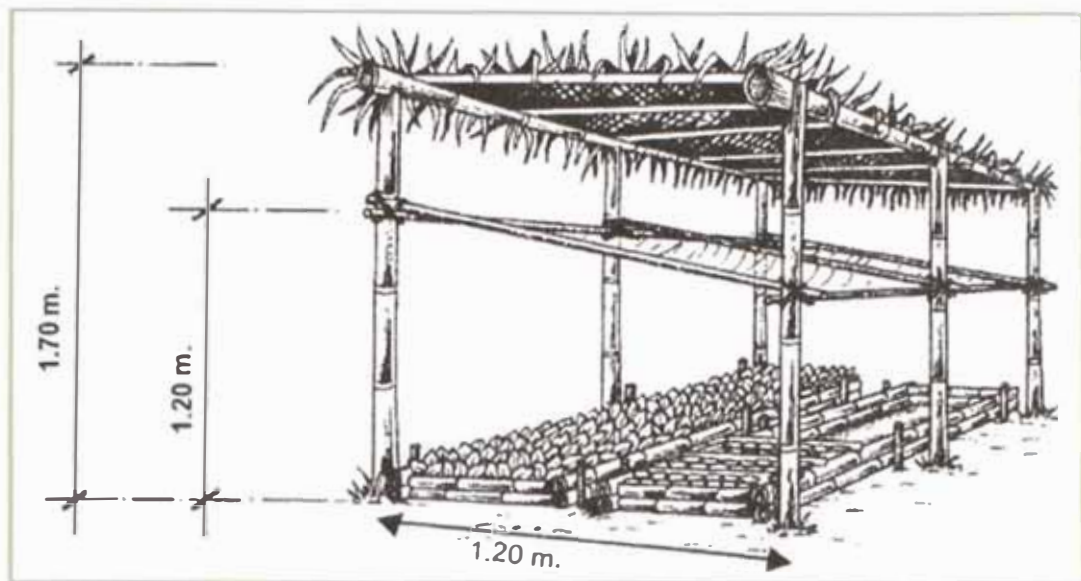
Detalles de dimensiones del vivero y sombra adicional
